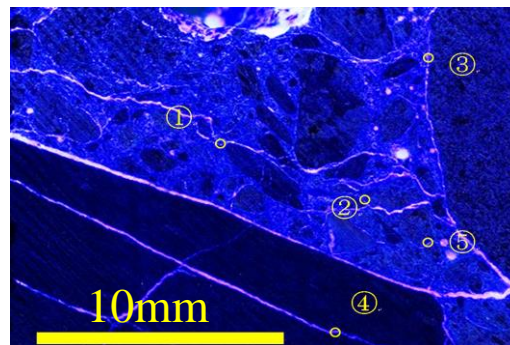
ひび割れ幅の評価に用いた写真（試験体 No2）
